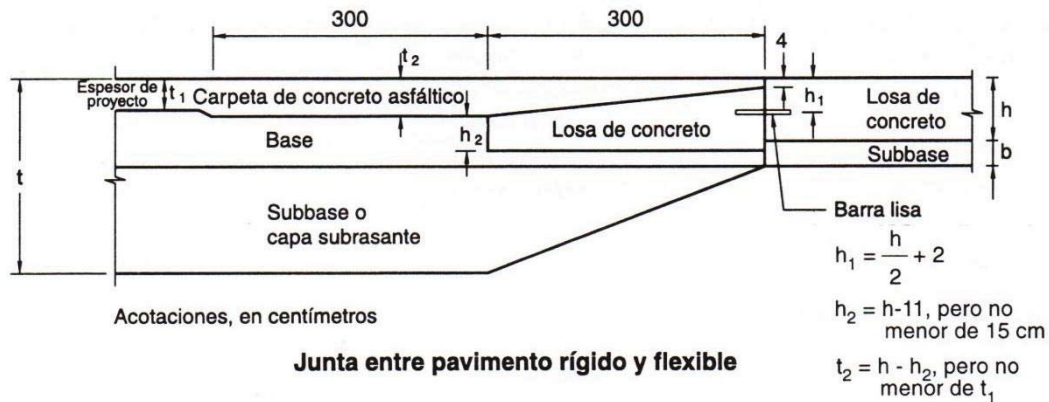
Juntas para unir pavimentos existentes con un pavimento rígido nuevo
